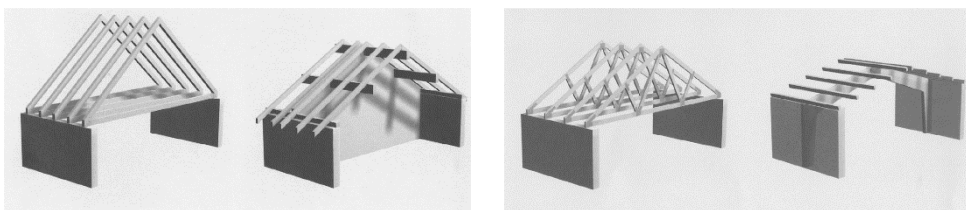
Sistemas de cobertura, segundo Kolb (2008): vigotas ligeiras, caibros sobre vigas longitudinais, asnas e vigas sobre pórticos.
